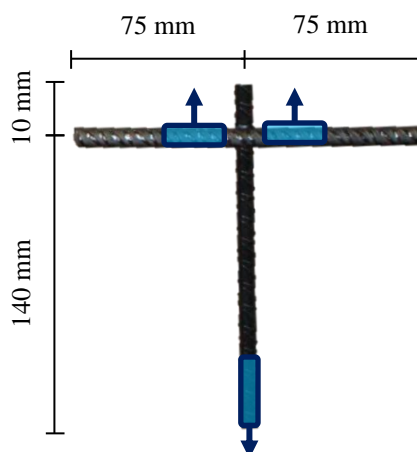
Representação dos pontos de aplicação da força de corte, num provete electrossoldado, num ensaio de corte à soldadura.
